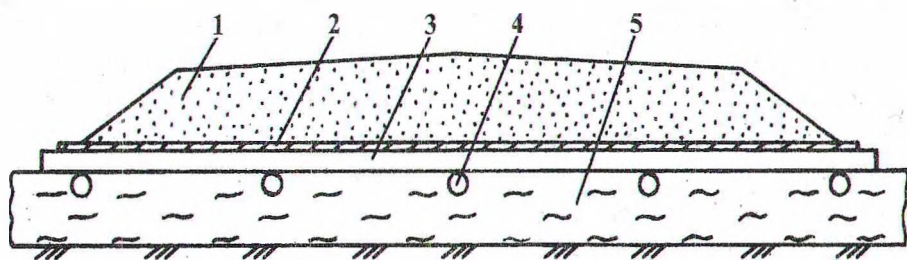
Дорожная конструкция, поперечный разрез: 1 – слой покрытия; 2 – прослойка из СТМ; 3 – поперечные элементы; 4 – продольные лаги; 5 – основание из слабого грунта
